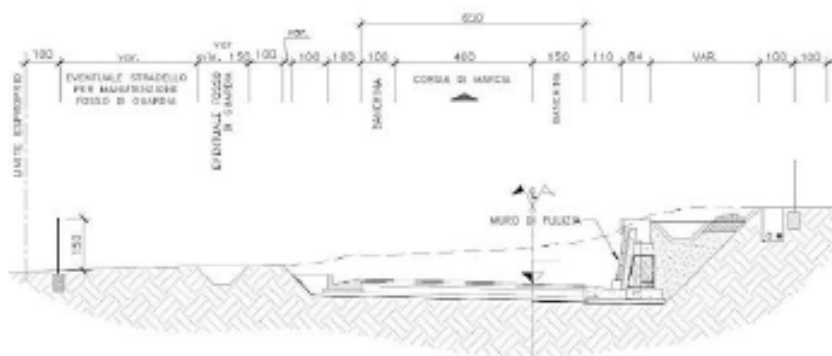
sezione tipo Rampa monodirezionale in trincea
